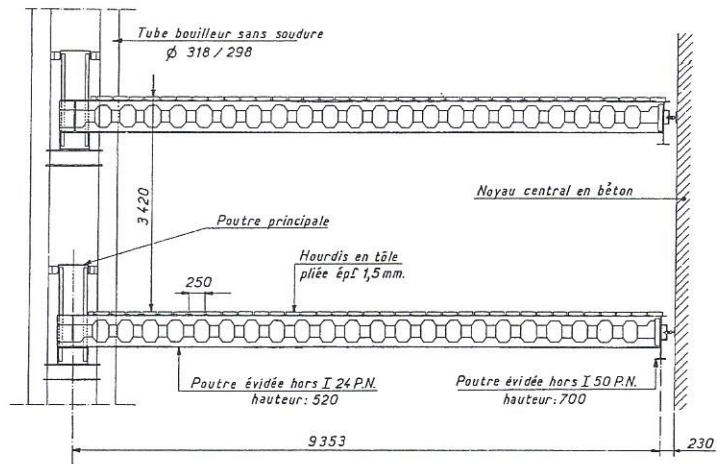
Coupe verticale de détail dans les planchers métalliques.
